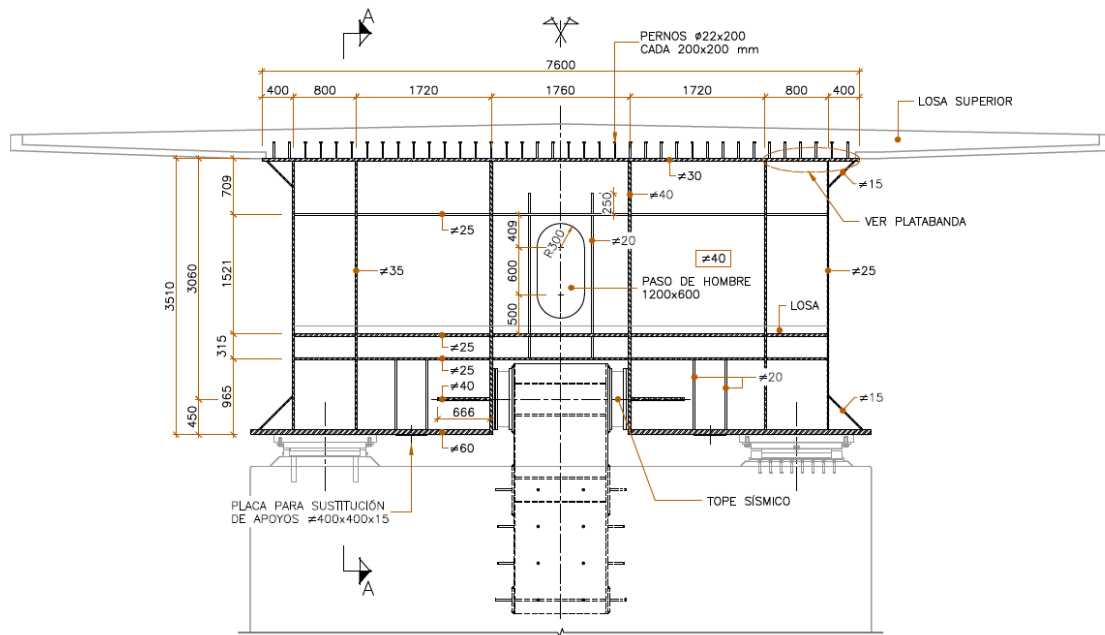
Alzado de los marcos transversales tipo 2 y 6. Fuente: Proyecto de construcción de plataforma del corredor mediterráneo de Alta Velocidad Murcia – Almería.
